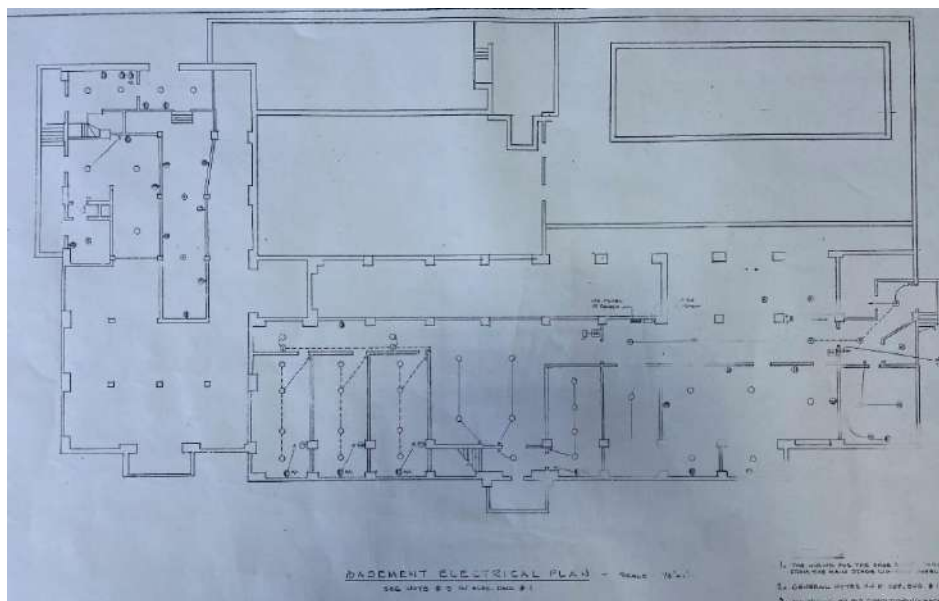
Planos Originales del Edificio Y.M.C.A. Nivel del Sótano
